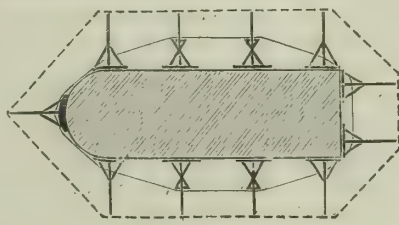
Grundriss der Rüstung für einen Thurm Pfeiler.
